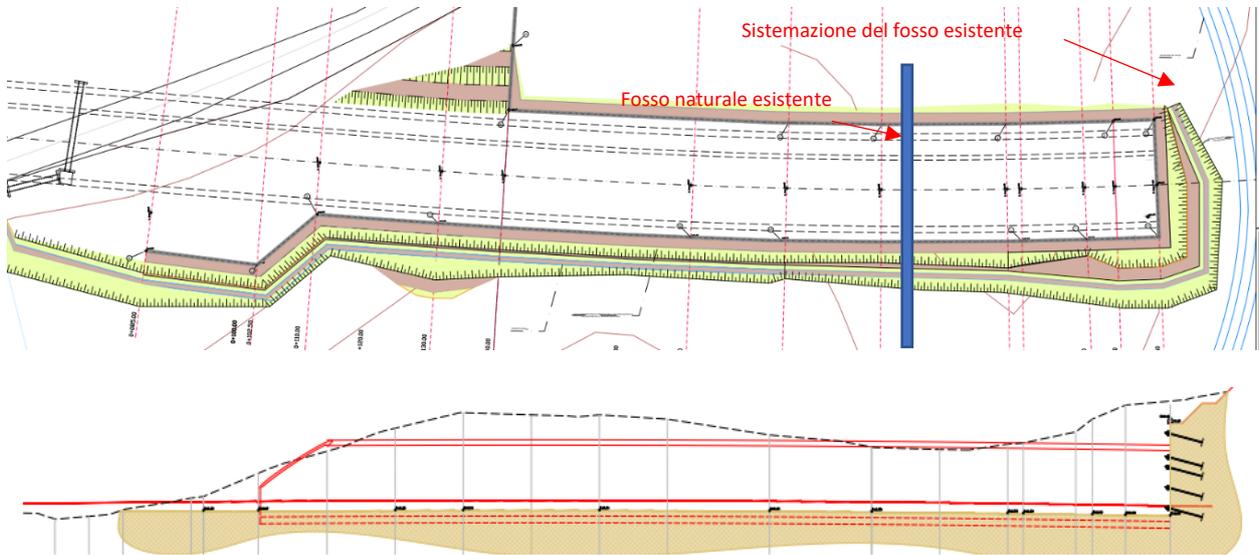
Planimetria imbocco Ovest Progetto Definitivo
